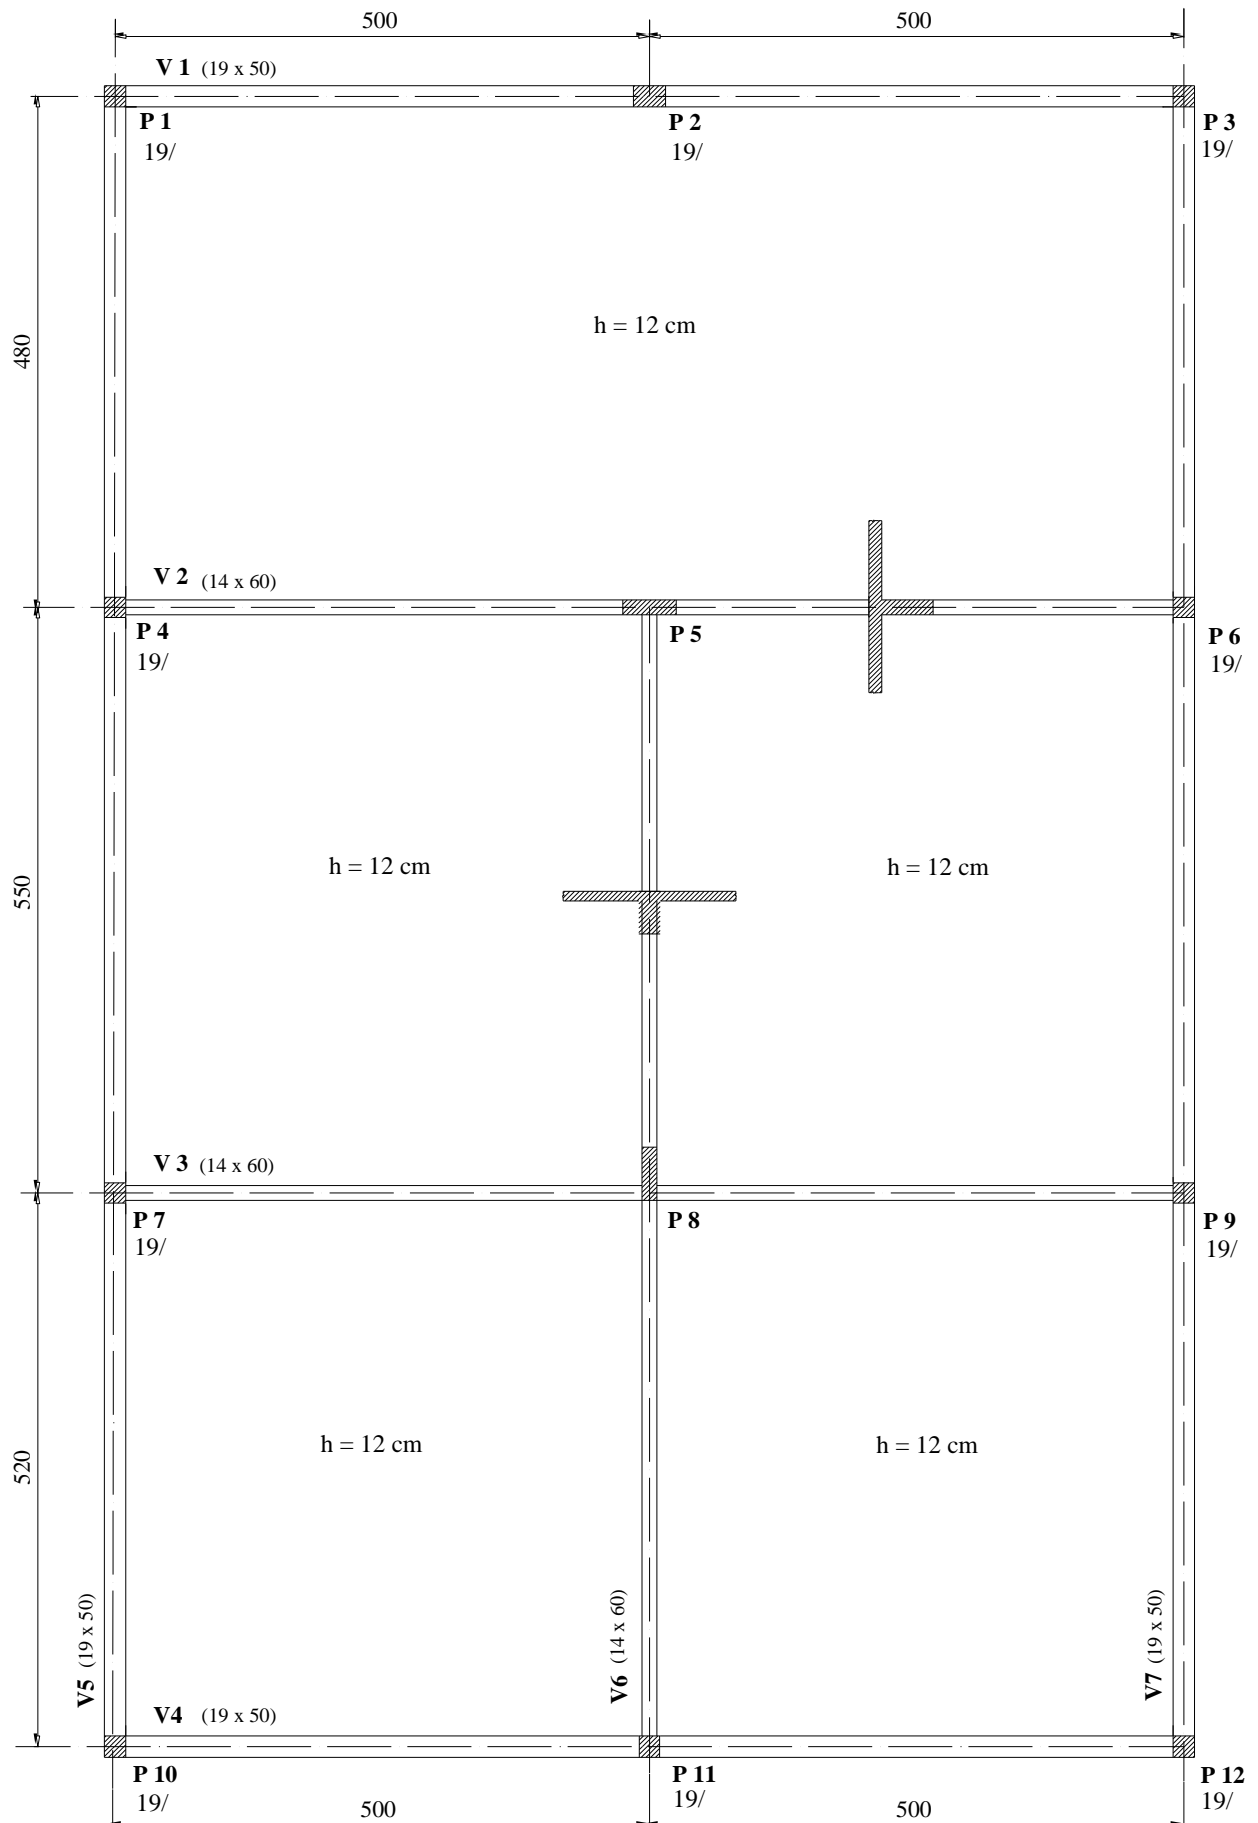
Planta de fôrma do pavimento tipo do edifício.
